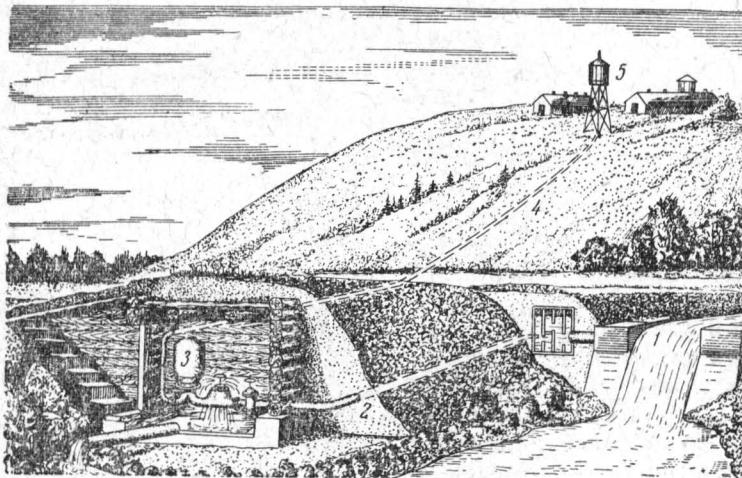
Схема установки гидравлического тарана для водоснабжения животноводческой фермы:
